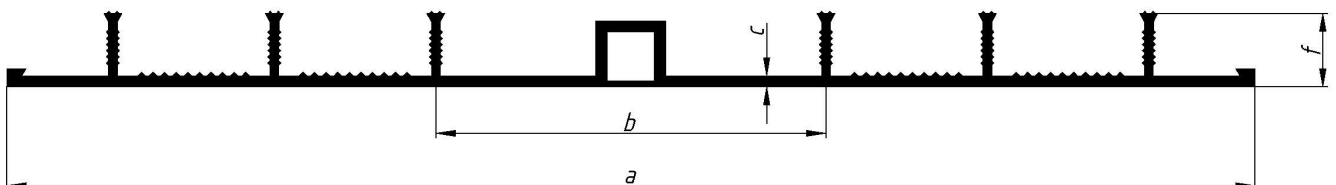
Гидроизоляционная шпонка «ПрофиБанд NN DA 320 NB» без системы инъекционных шлангов
